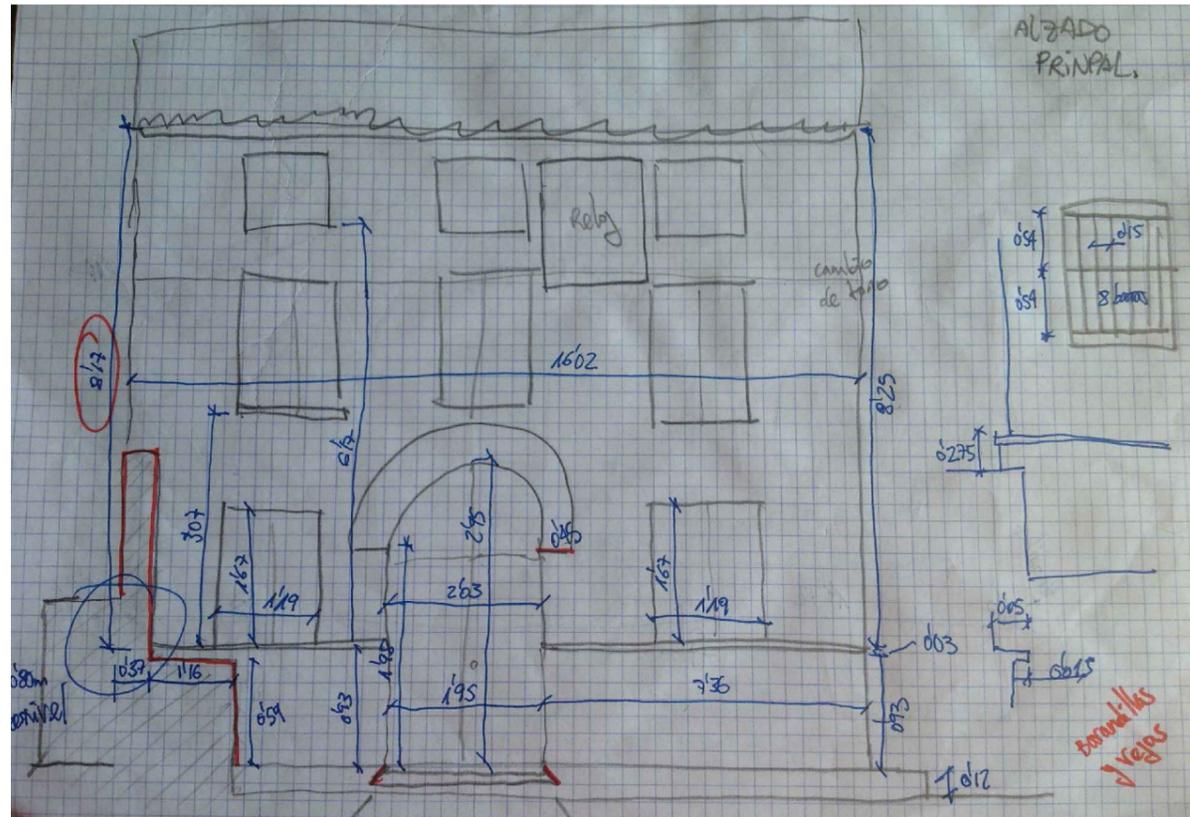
Fachada principal (SE). 2014. Fuente: elaboración propia.
